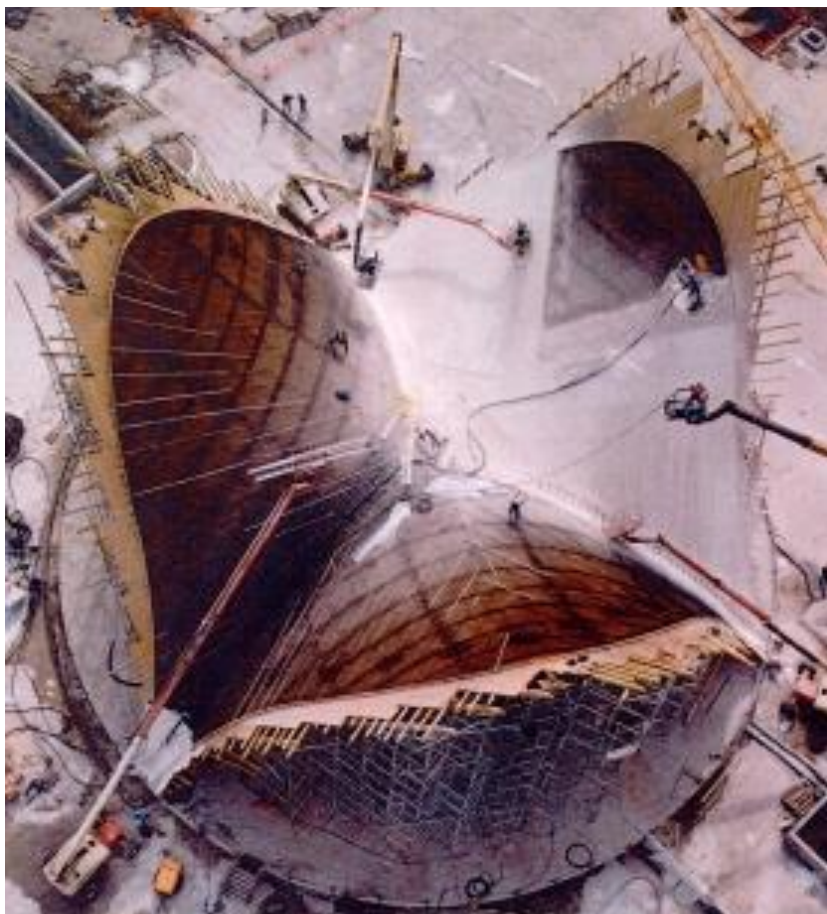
Торкрет бетонирование оболочки «мокрым» методом;
